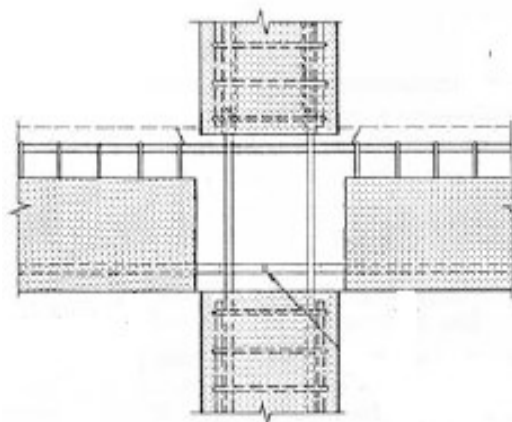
Representação da ligação recorrendo a betonagem integral do nó e da laje (STUPRÉ, 1981).
